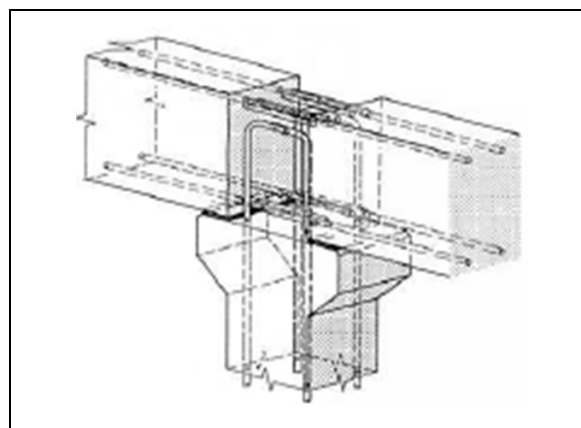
Ligação por betonagem *in situ* do nó (Stupré, 1981)
